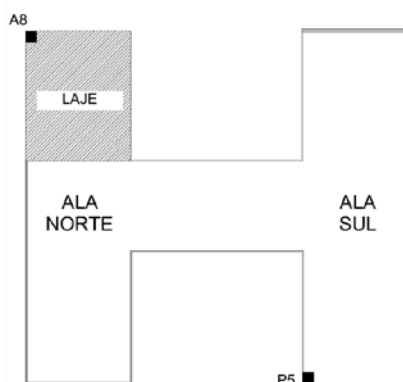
Croqui do Edifício com locação dos dois pilares e laje ensaiados.
